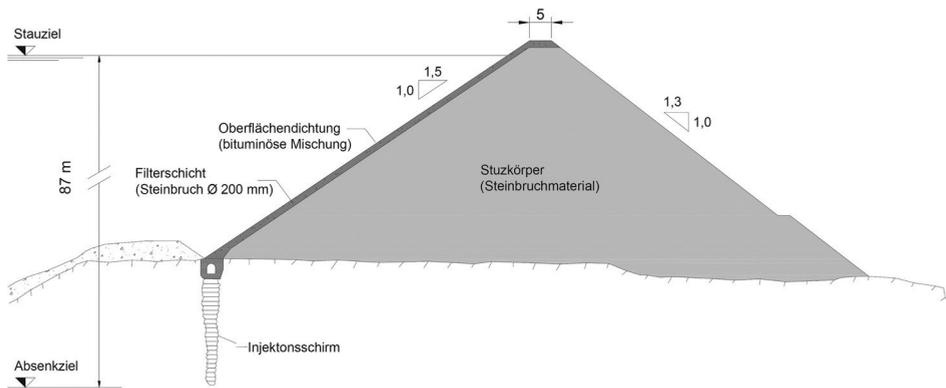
Beispiel für einen Steinschüttdamm mit Oberflächendichtung auf einer Filterschicht (nach [29])
